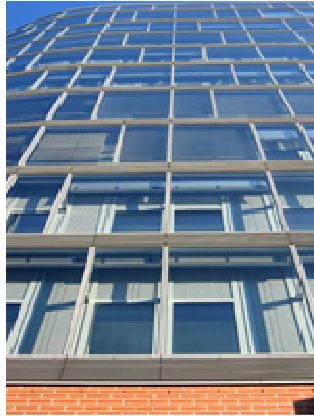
Fassaden-ausschnitt einer Doppelfassade, Bürogebäude am Potsdamer Platz, Berlin
